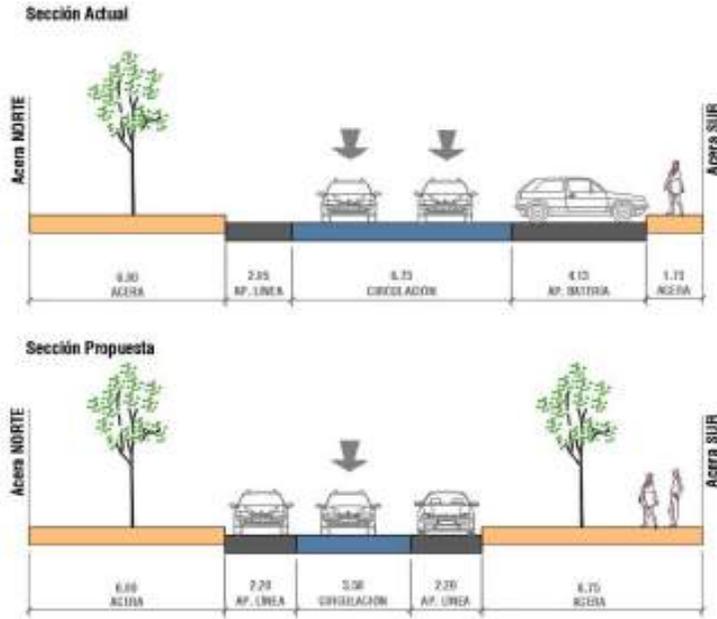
Sección tipo F propuesta en calle Real. Fuente: DOYMO.
